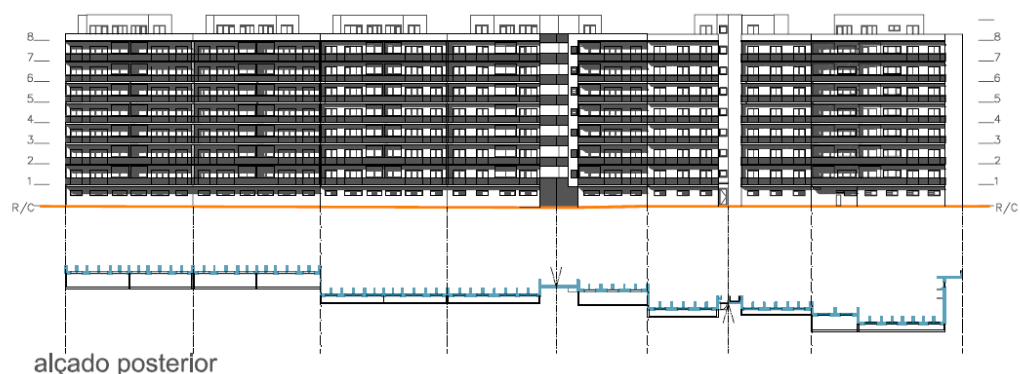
Intervenção alternativa no bloco 10. Alçado (escala 1/1000).
